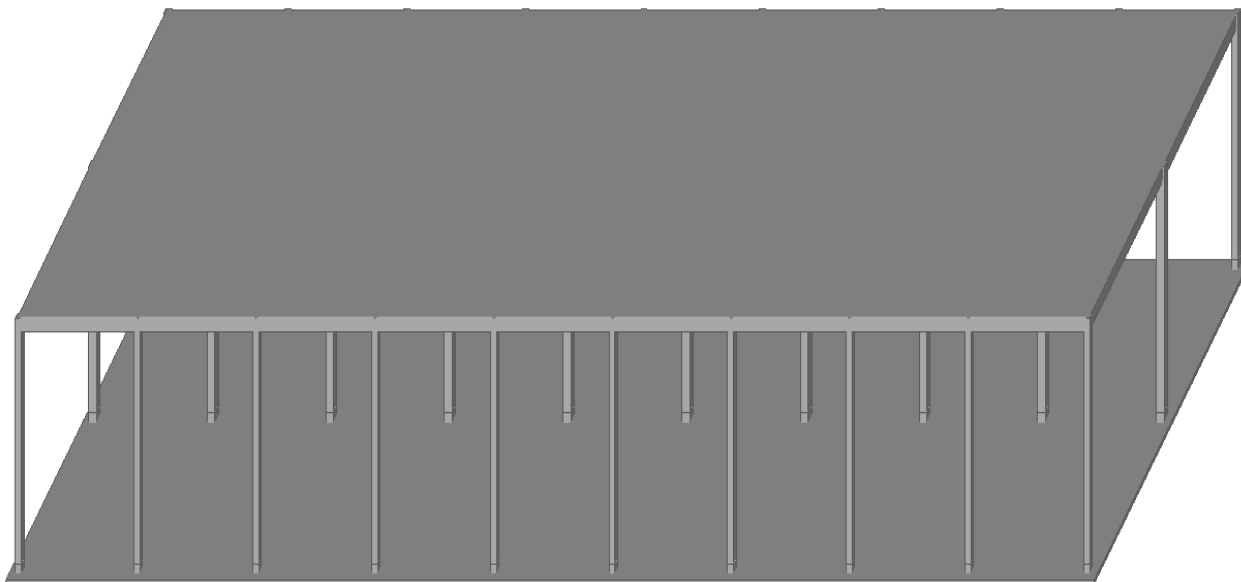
Просторова модель залізобетонної будівлі цеху
